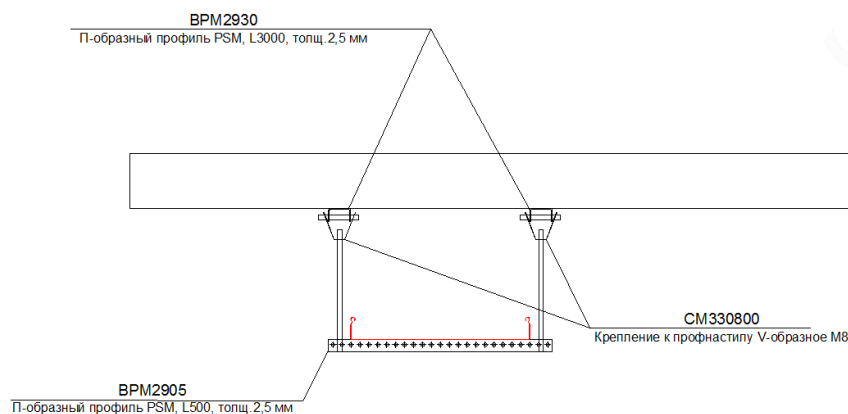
Общий вид подвеса с помощью V-образного крепления
